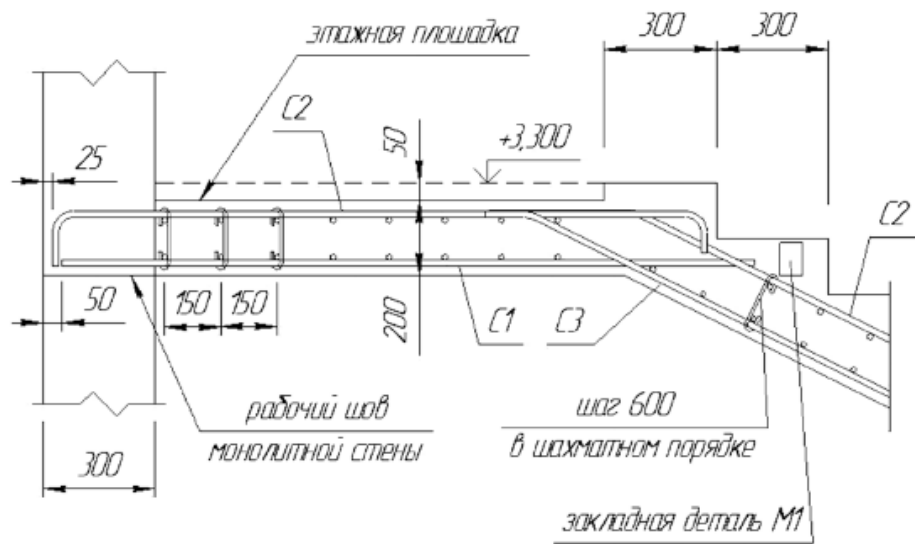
Схема армирования монолитной лестницы (сопряжение лестничных площадок со стеной и маршем)
